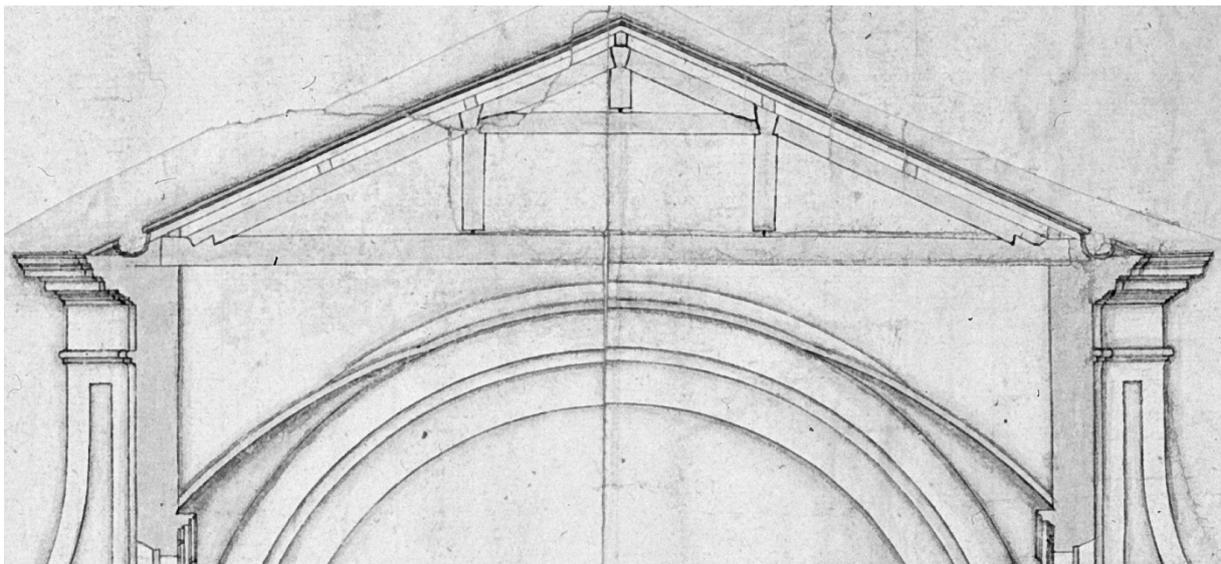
München, Theatinerkirche: Ausschnitt aus dem sogenannten BARELLI-Plan mit Darstellung der Konstruktion des Dachwerks<sup>89</sup>
